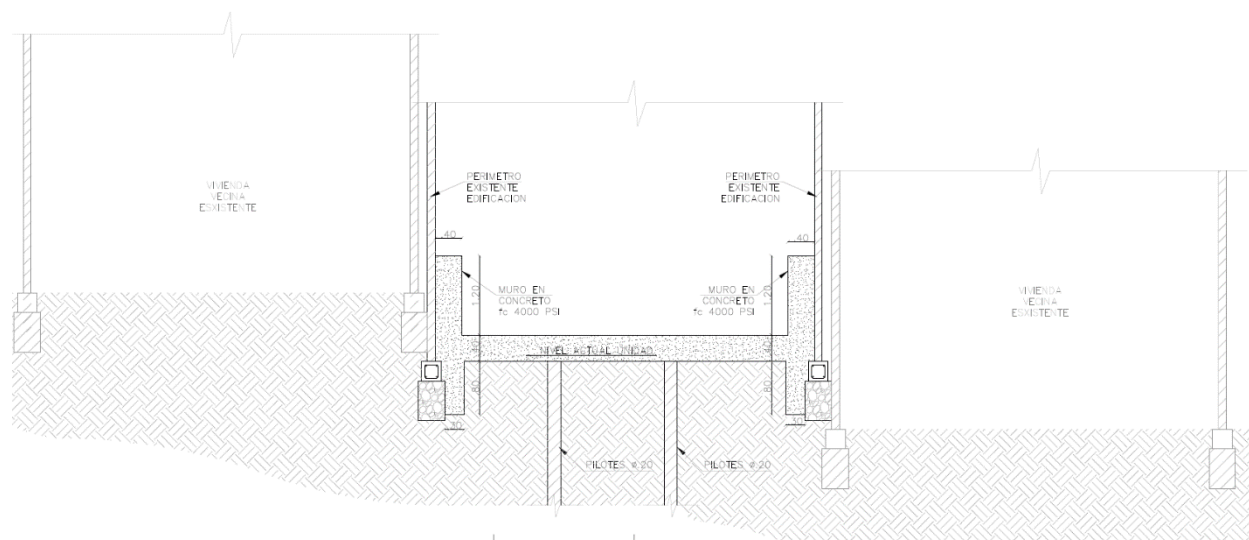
Esquema de solución adoptada de construcción de muro, demoliendo la casa. Fuente propia 2018.
